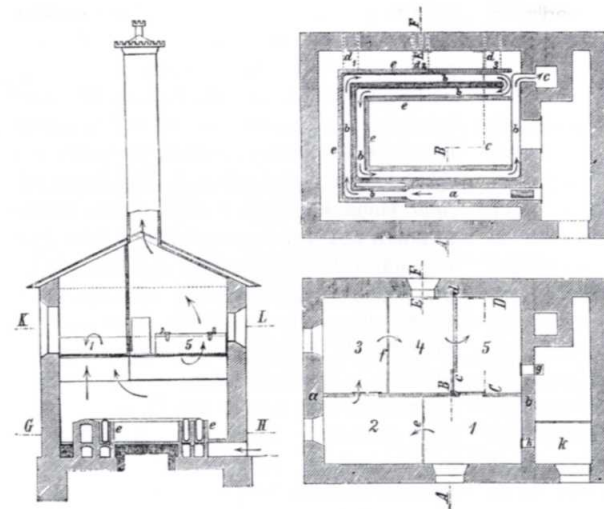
Gallandova pneumatická sladovna vyráběná firmou F. Ringhoffer
